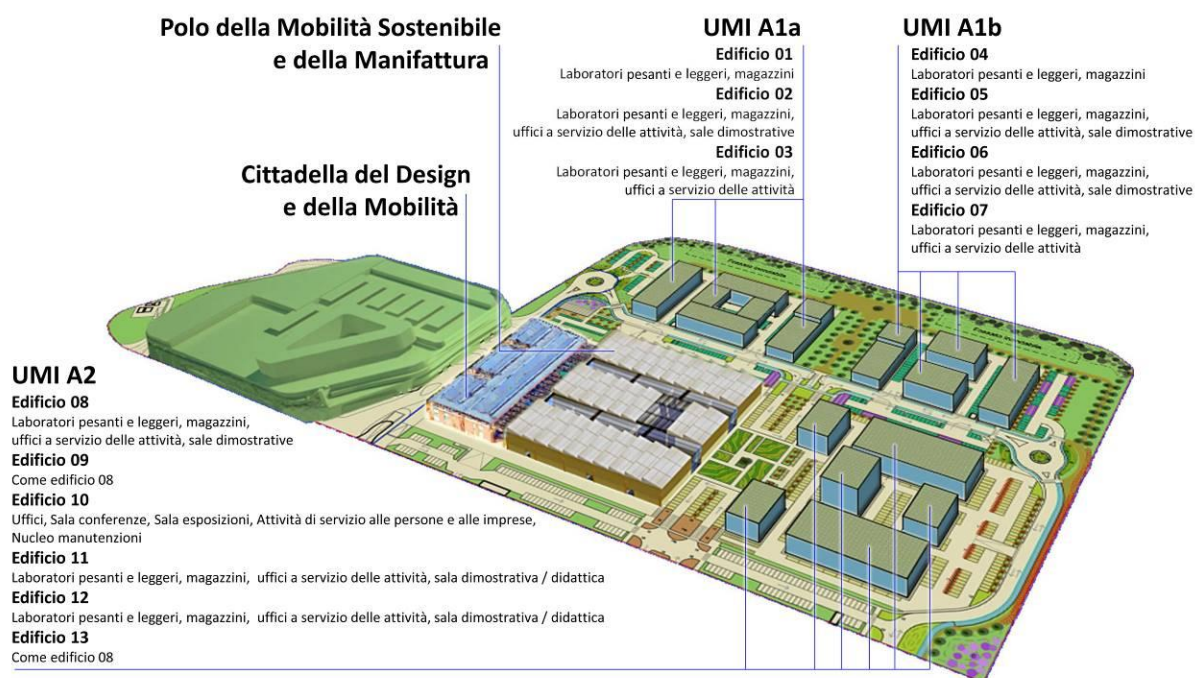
Planivolumetrico del Piano Esecutivo Convenzionato
